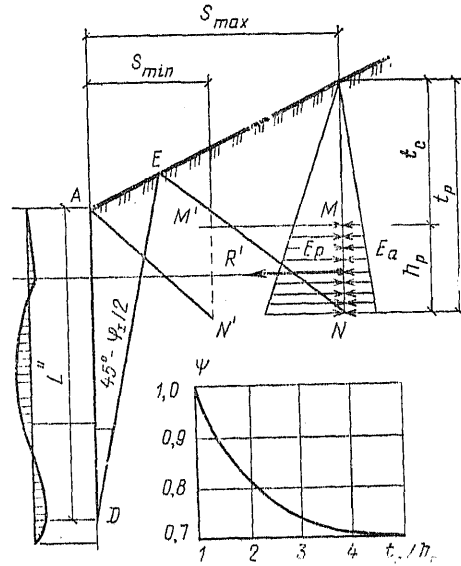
Расчетная схема нагрузок, действующих на анкерную плиту
